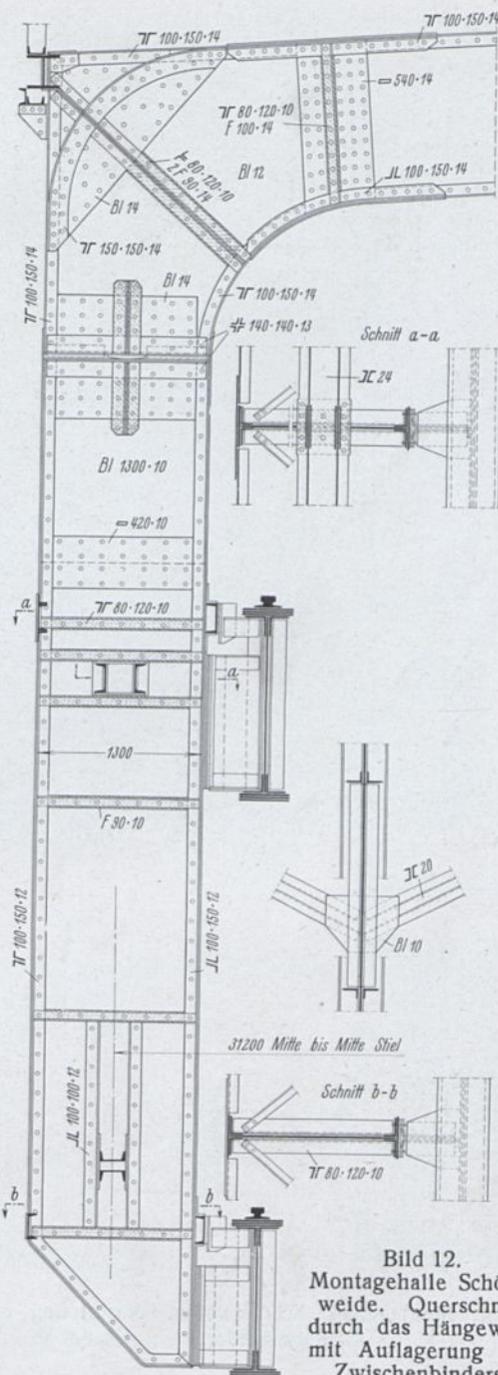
Montagehalle Schöneeweide. Querschnitt durch das Hängewerk mit Auflagerung des Zwischenbinders.
